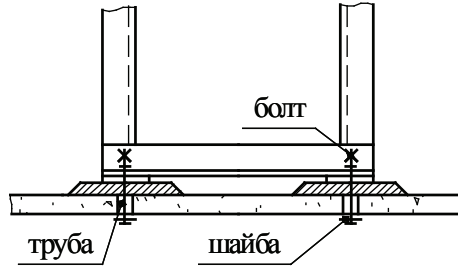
Крепление конвейера болтами, размещенными в трубах
